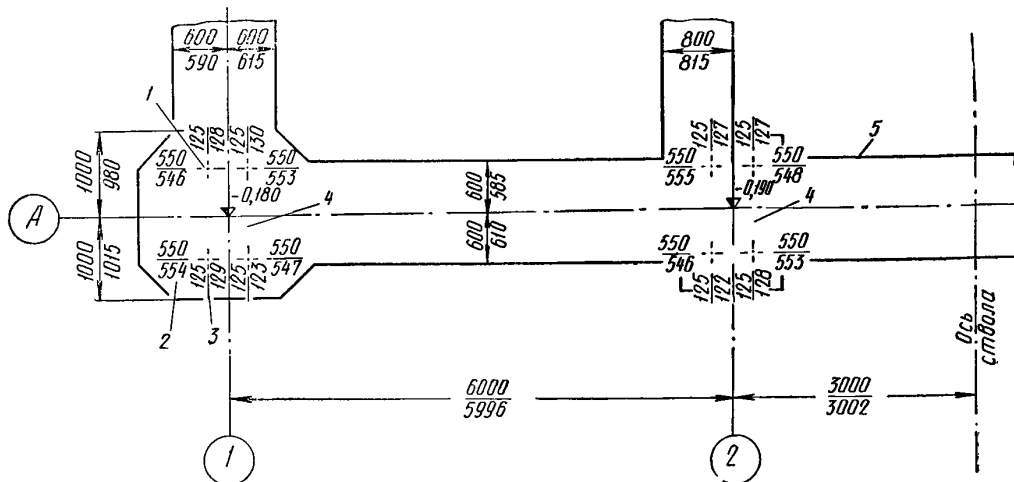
Пример исполнительной схемы части фундамента под металлический башенный копер
